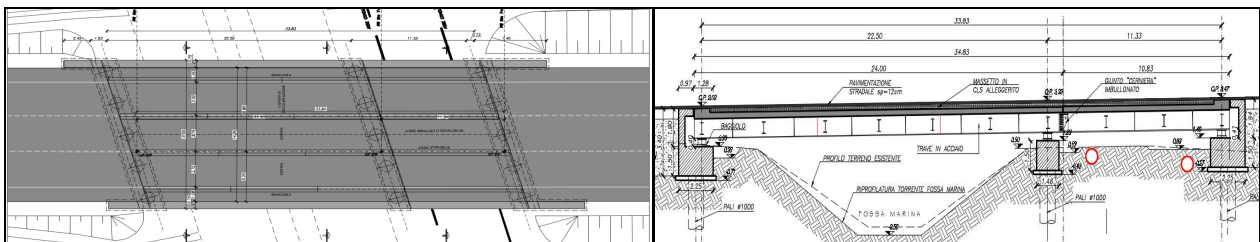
Pianta e Sezione longitudinale Ponte Fossa Marina
